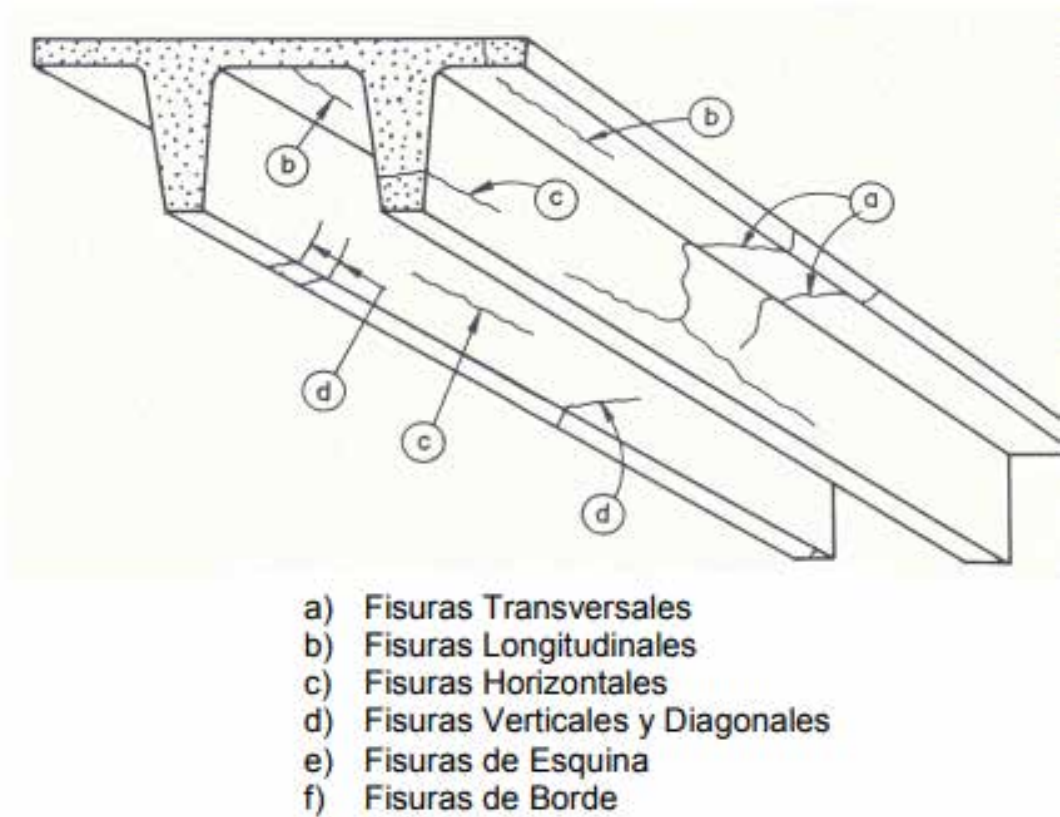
Fisuras en la fabricación, transporte y manejo de miembros de concreto reforzados o preesforzados.
